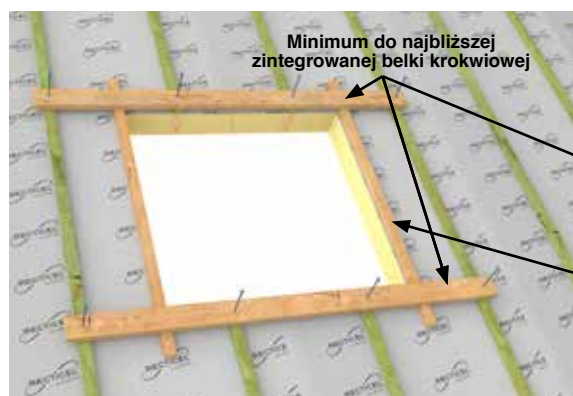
przygotowanie do wykonania otworu na okno dachowe
